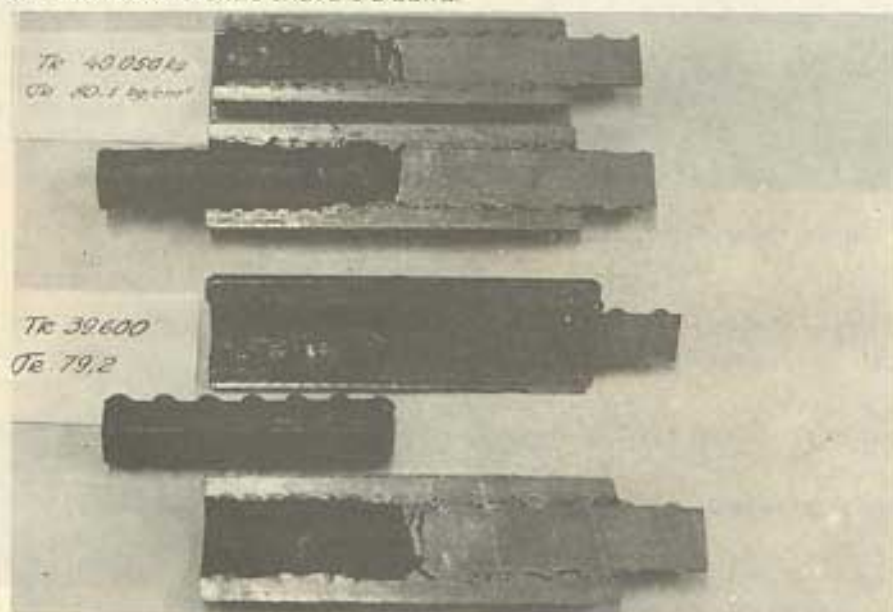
Ilustração do preenchimento entre as nervuras da luva e das barras - Itaipu
